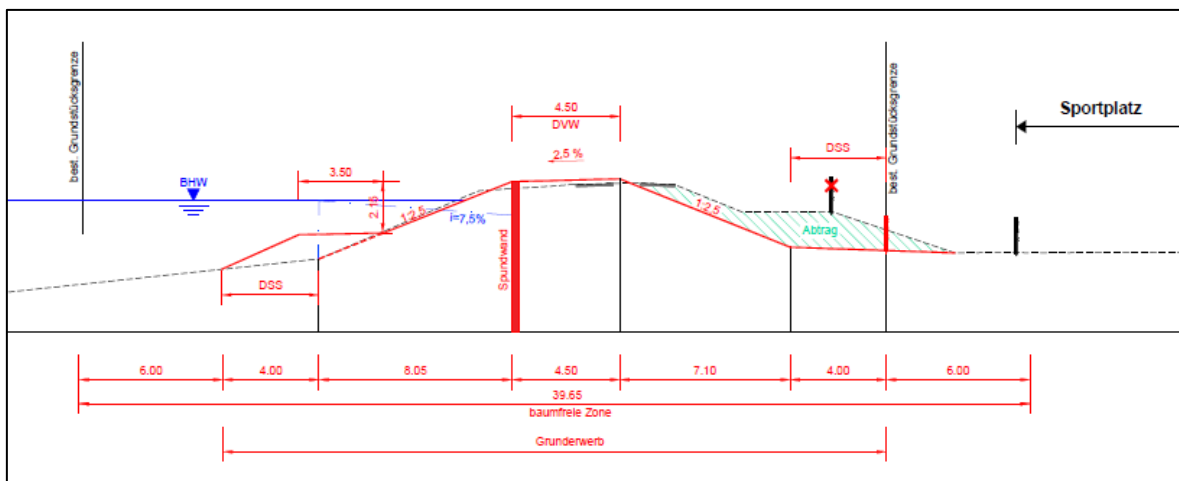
Dammprofil Damm-km 0+361,00 Sportplatz
